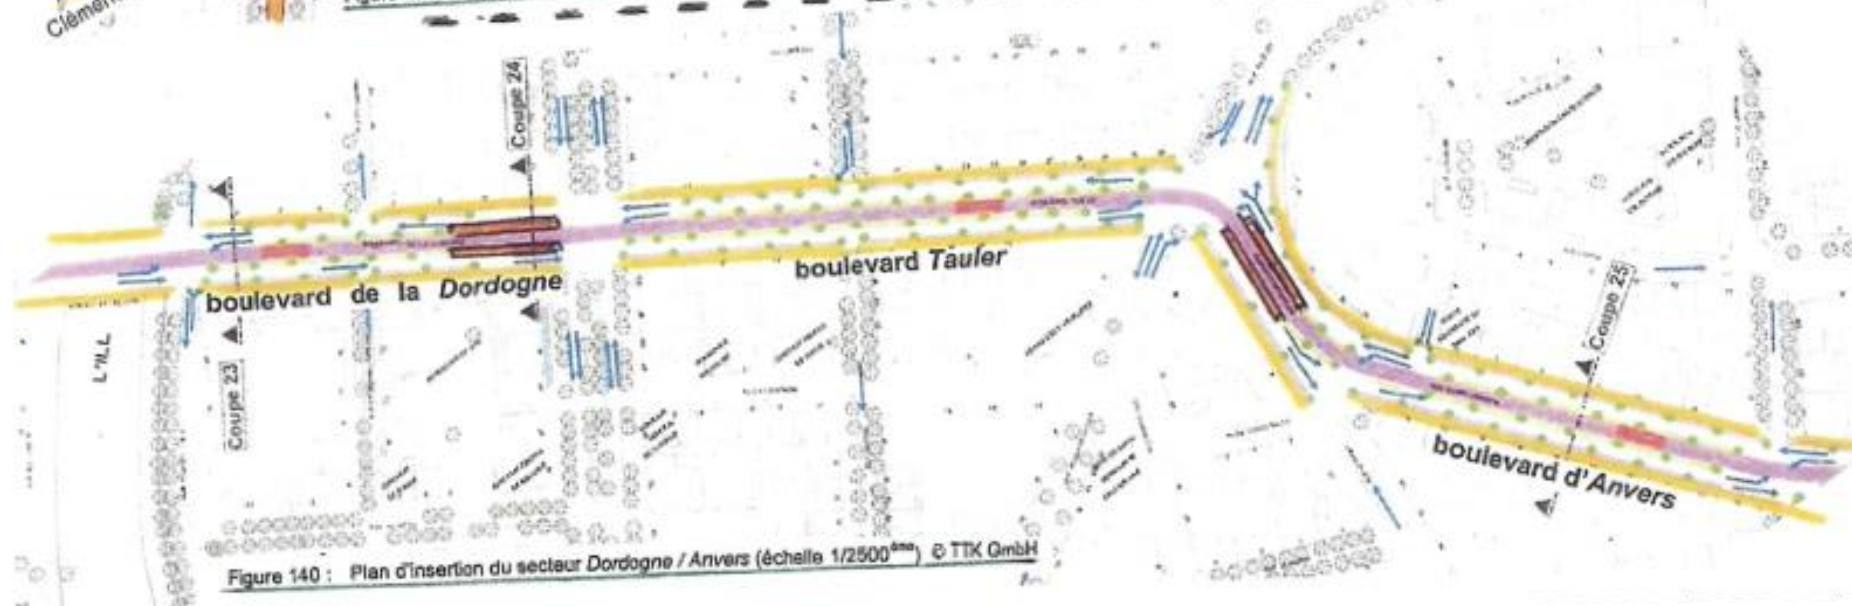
Plan d'insertion du secteur Dordogne / Anvers (échelle 1/2500) © TTK GmbH
